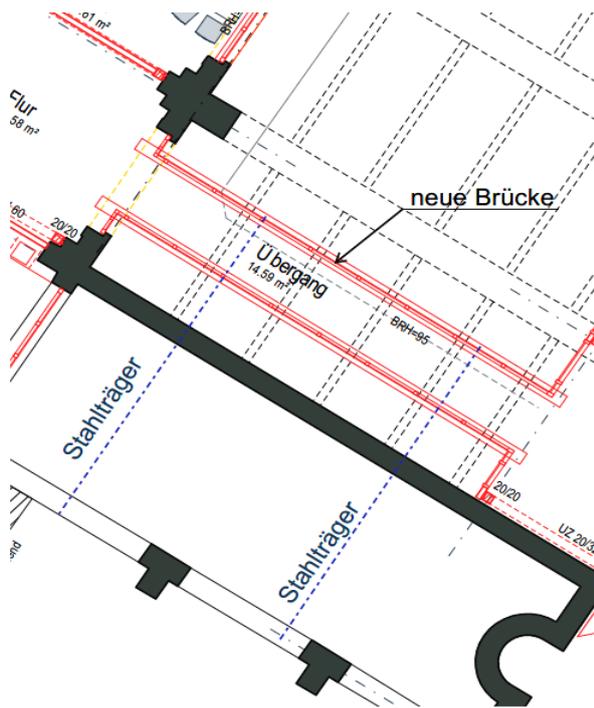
Grundriss Brücke [Triade Architekten]
